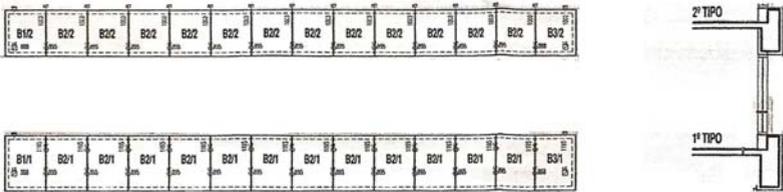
Paginação com elevação e corte das placas pétreas aplicadas em fachadas. Cota
